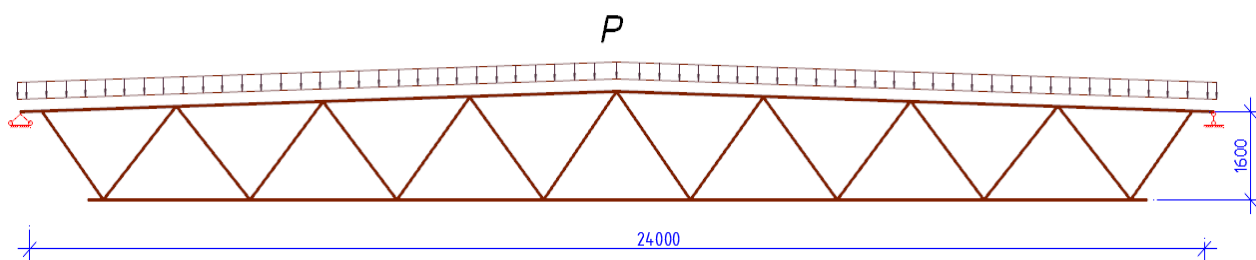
Схема загрузки стропильной фермы снеговой нагрузкой на всем пролете
